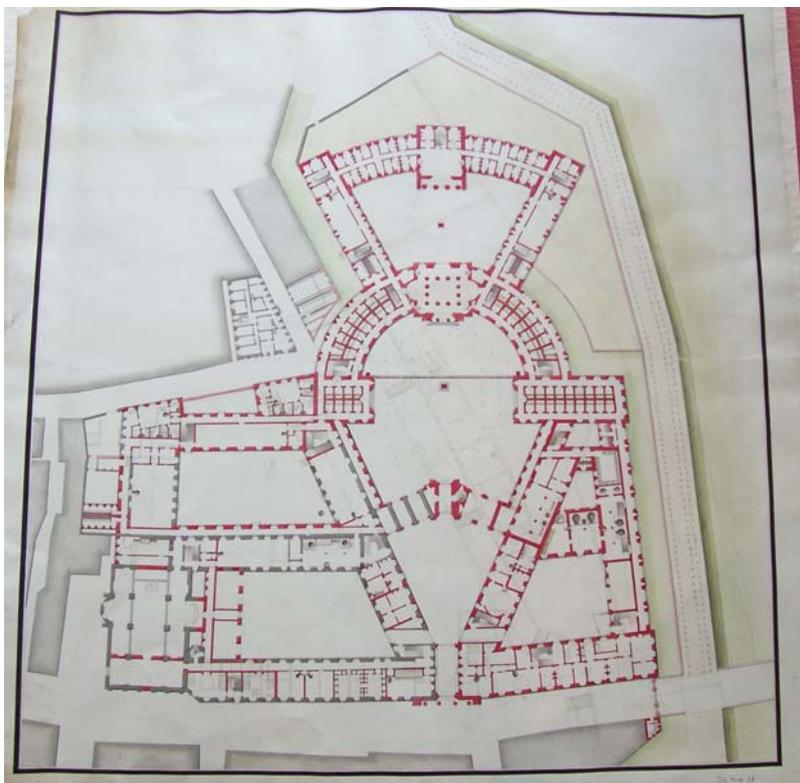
le plan du rez-de-chaussée, AVCUS, 315 MW 11.
